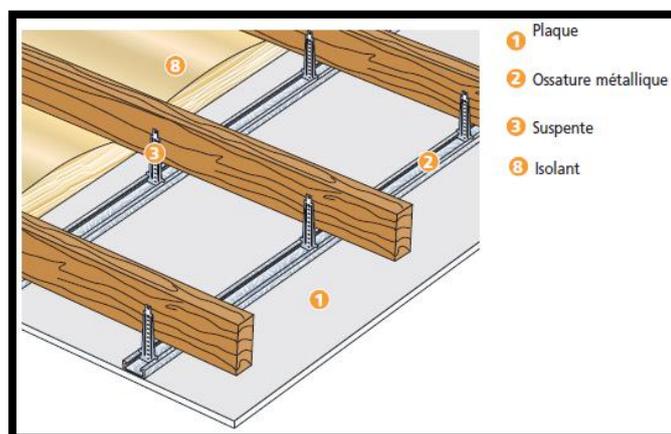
représente le mode de fixation des faux plafonds¹¹³
